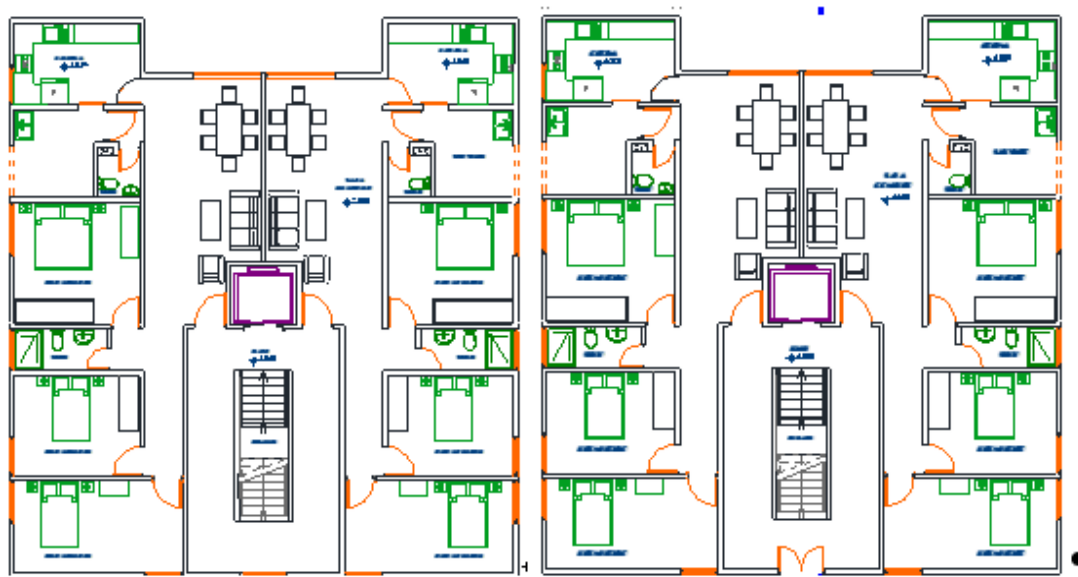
Plano de planta y plano típico de niveles 2, 3, 4 y 5
